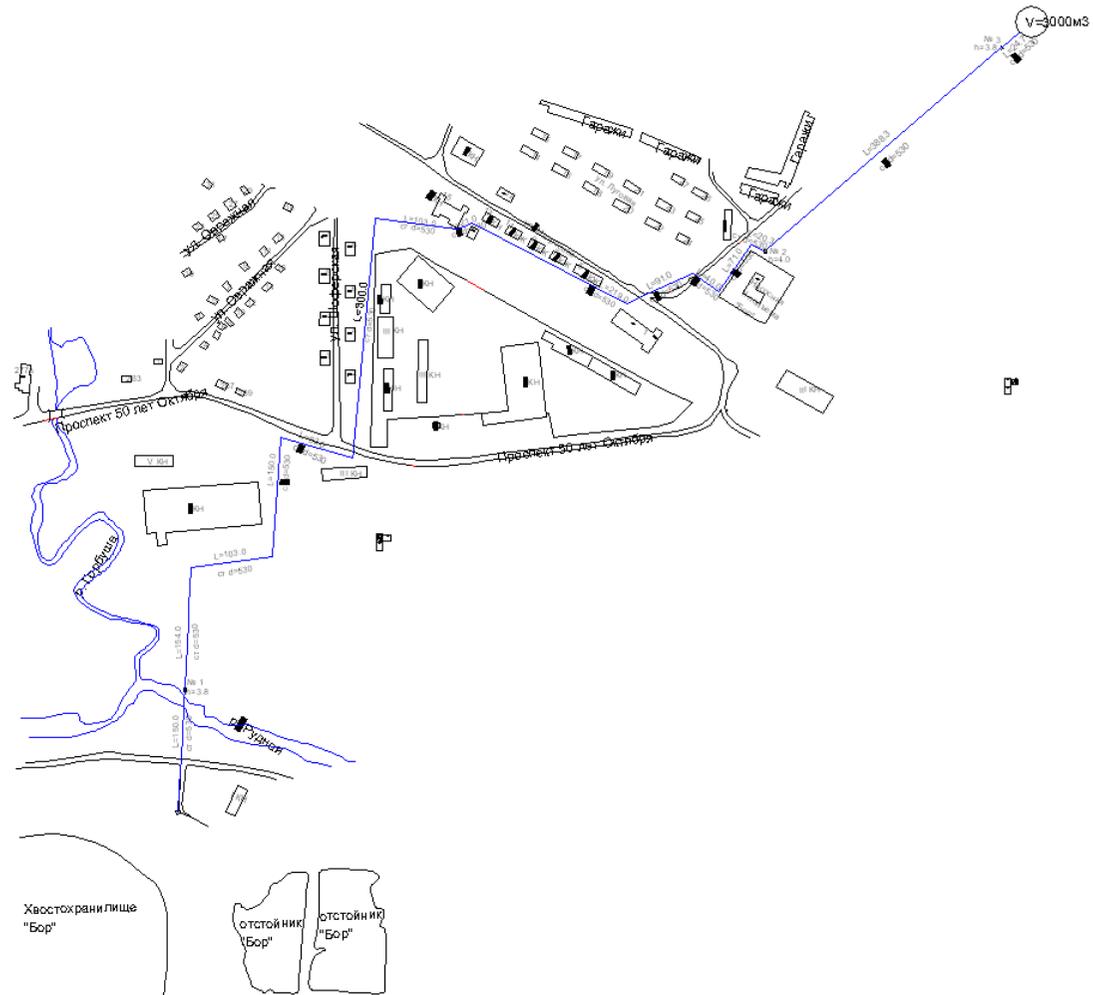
План магистрального водопровода от камеры до резервуара г. Дальнегорска
